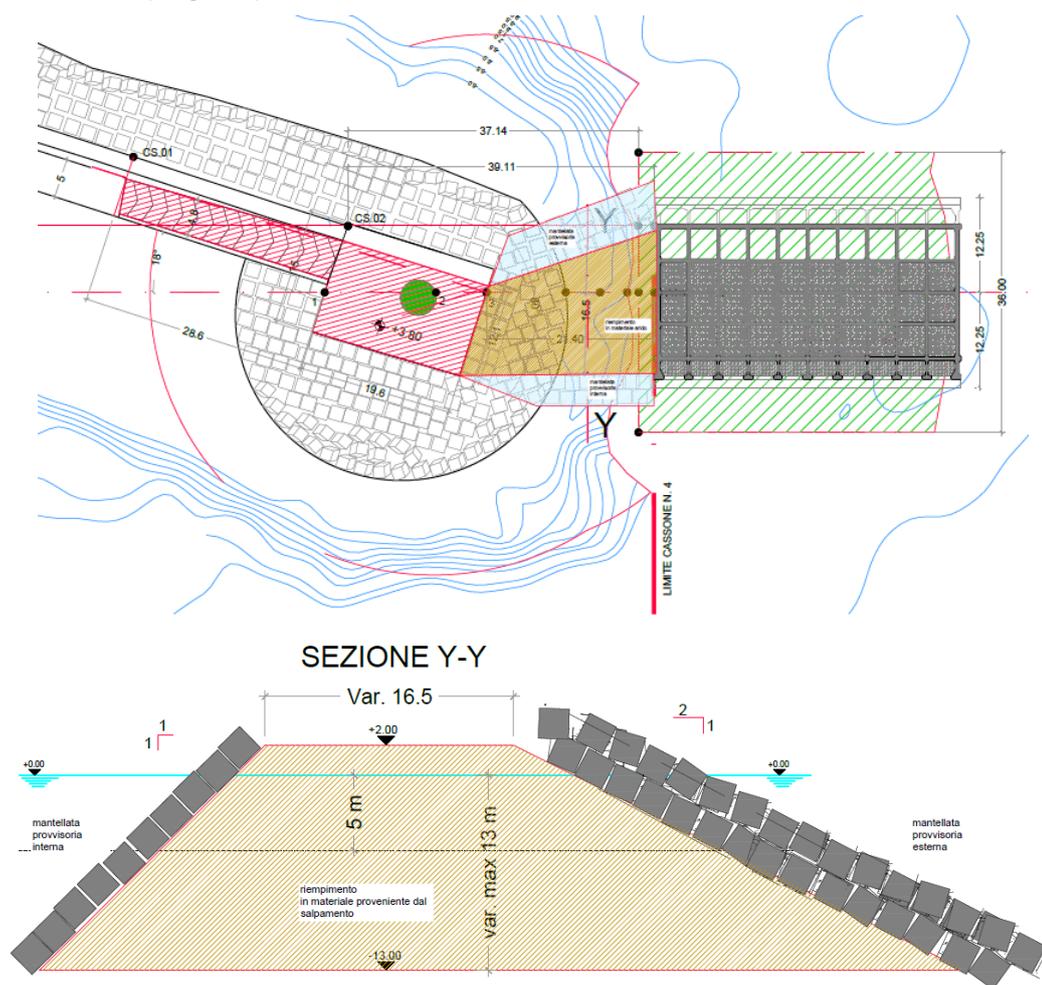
Progetto Esecutivo: stralcio planimetrico e sezione Y-Y della pista provvisoria di collegamento tra molo esistente e cassone n°4
